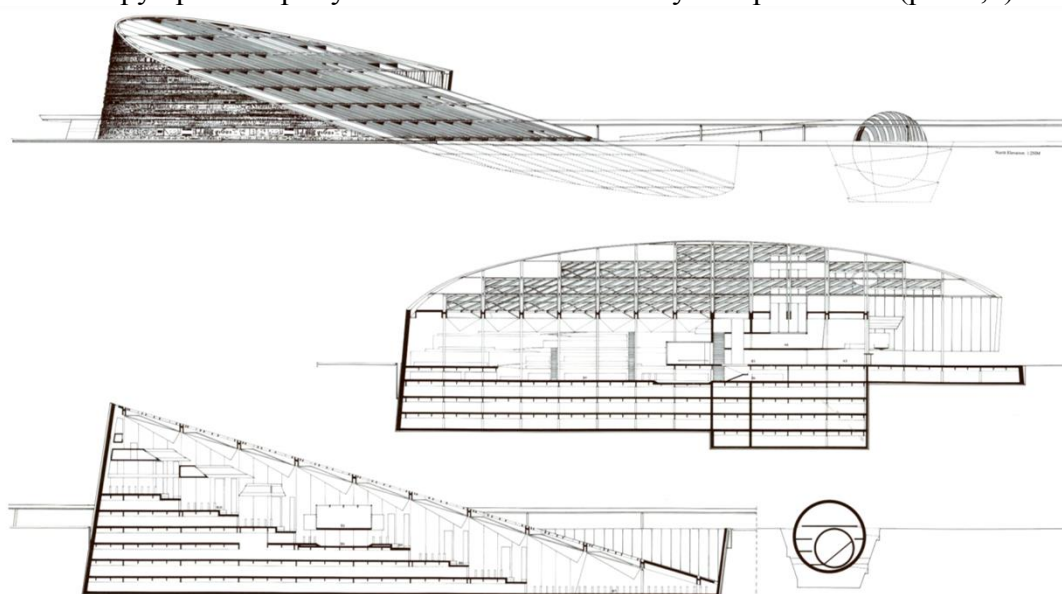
Библиотека Александрина: фасад, продольный и поперечный разрезы.
